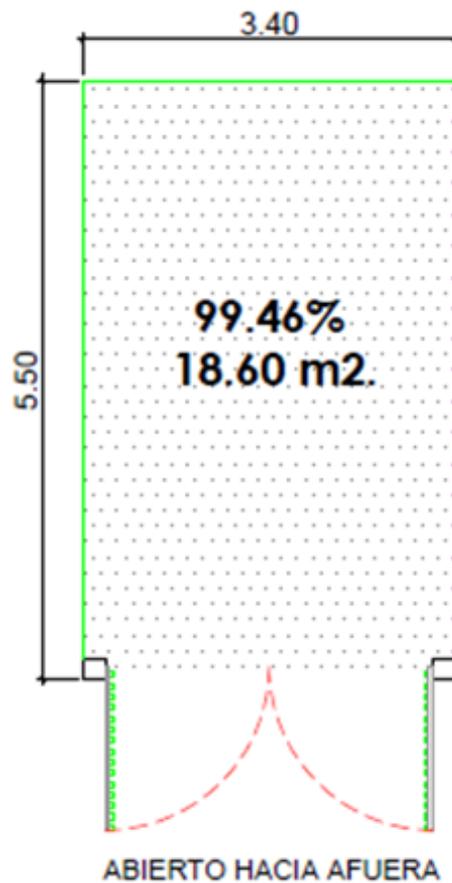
Vista en planta de la superficie del garaje con puerta hacia afuera.
